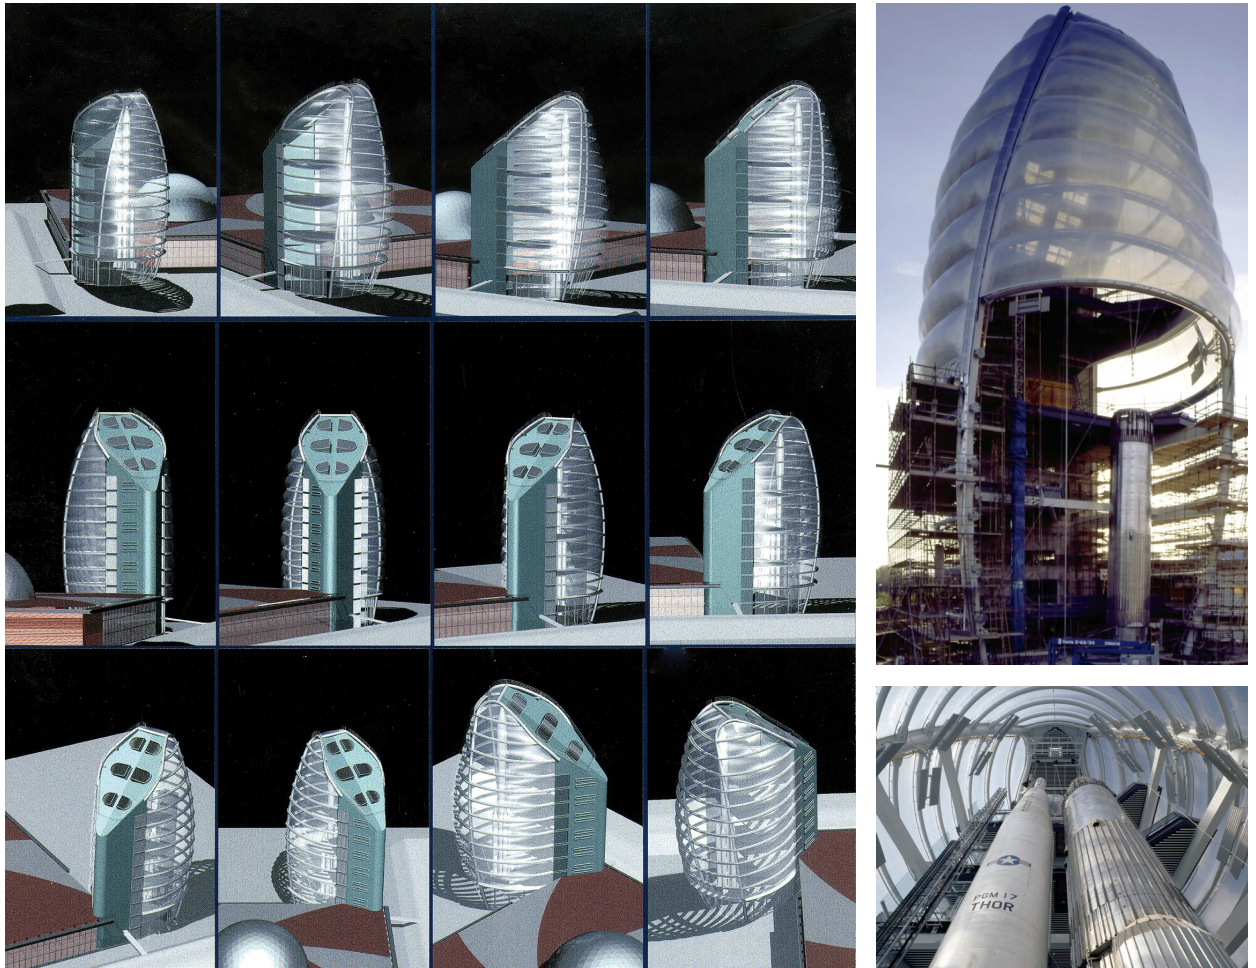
Izquierda: Diversas vistas de la torre de fachada textil del Museo del Espacio; Derecha arriba: Construcción de la fachada textil; derecha abajo: interior de la torre.
